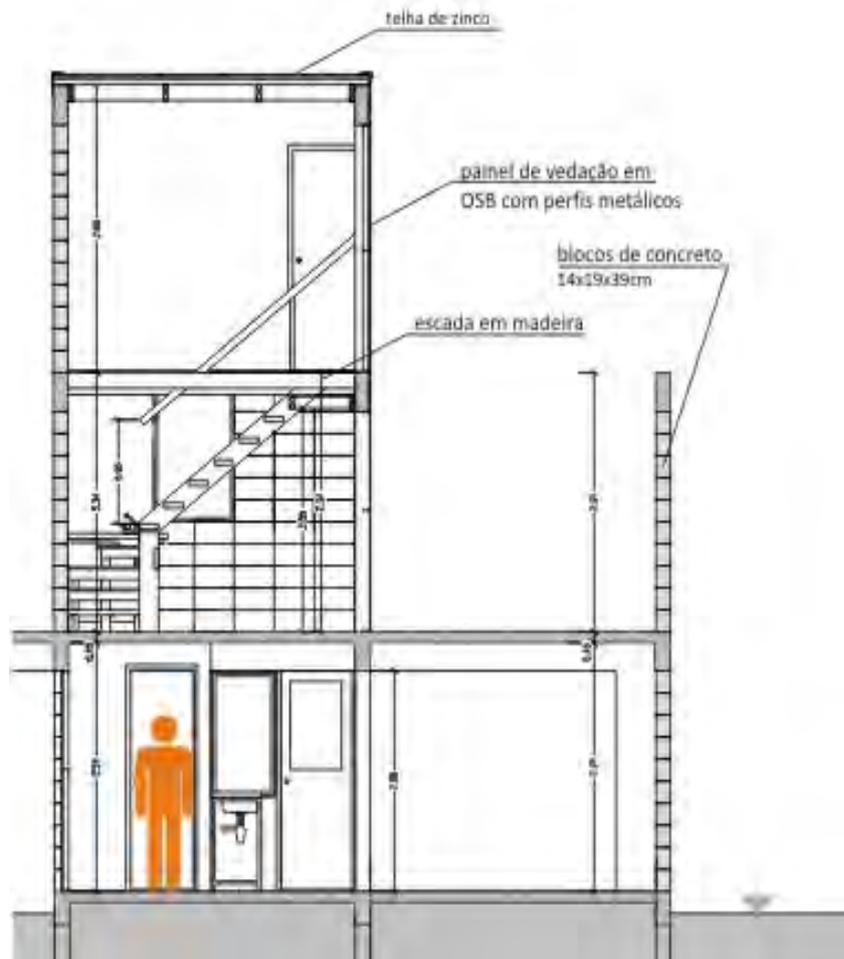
Corte de longitudinal da edificação tipo, com indicação de alguns materiais.
